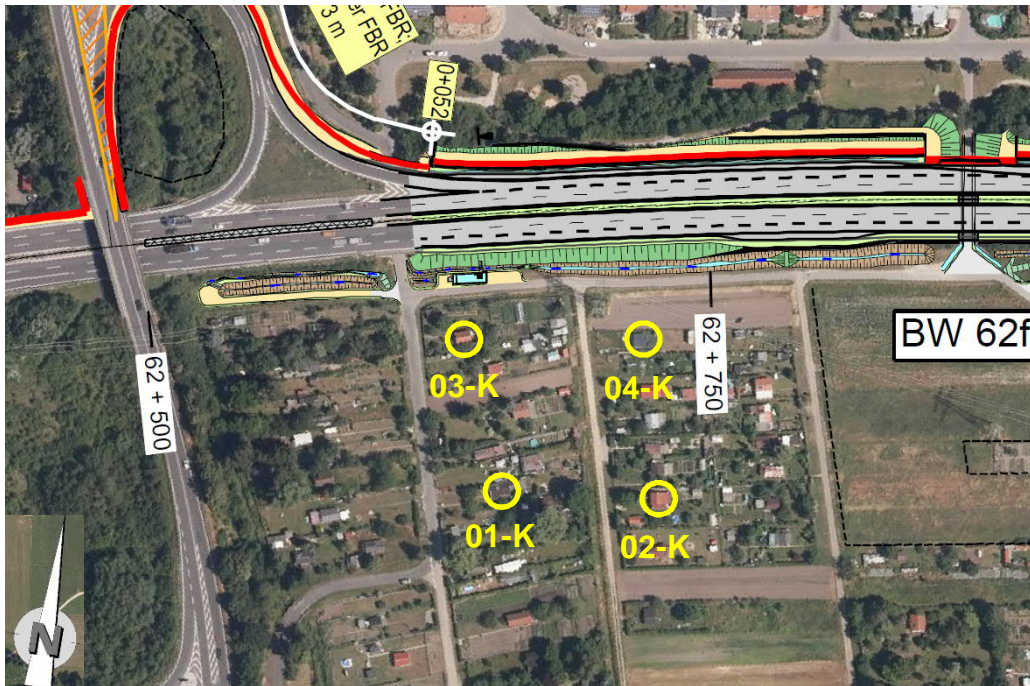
Auszug aus Übersichtslageplan U 3 Bl. 2 mit vier zusätzlichen Berechnungsorten (01-K bis 04-K) Kleingartenanlage
